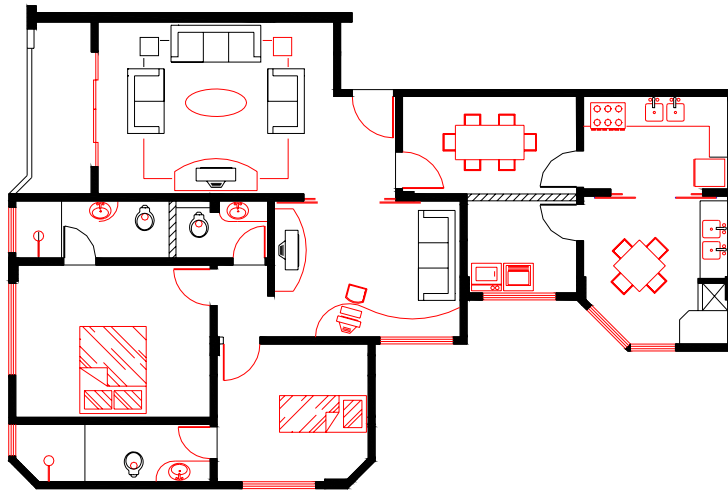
Planta Baixa do apartamento 602 – Estudo de caso B.
